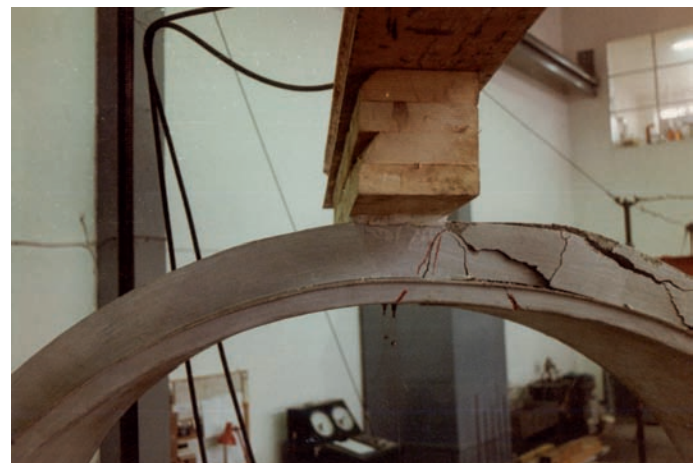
Rotura del tubo / Picture 3. Tube breaking.
